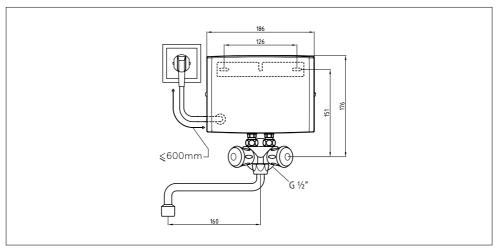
»Installationskizze mit Armatur« (Maßangaben in mm)
